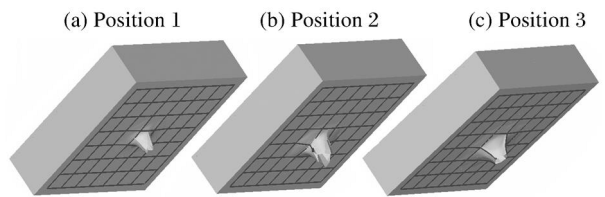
不同弹着点下钢筋混凝土靶的破坏情况
